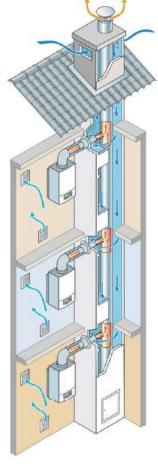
Conduit collectif Shunt rénové permettant de raccorder des chaudières à condensation étanches
